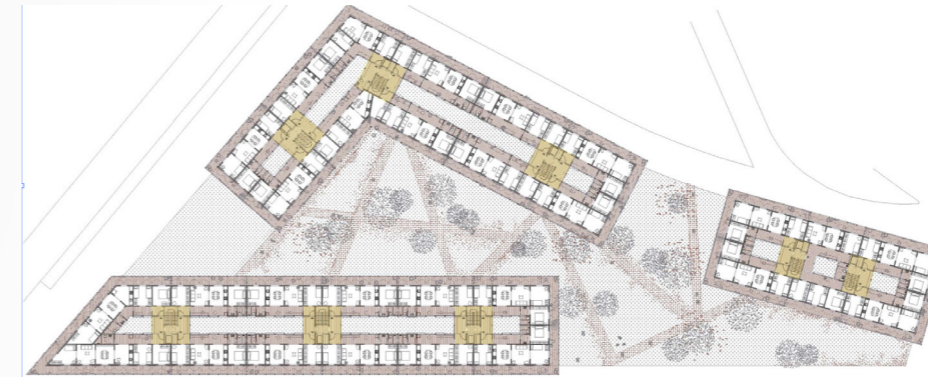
, Planta general, 136 viviendas en Gavá, H arquitectes, 2019
